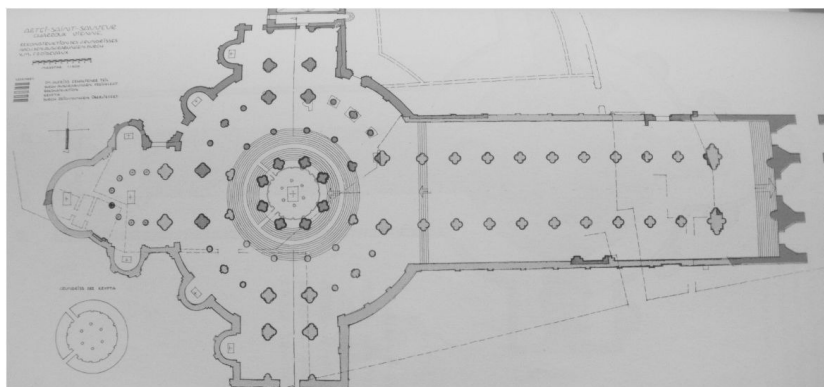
Grundriss, Saint-Sauveur, Charroux, 11.-13. Jh.
